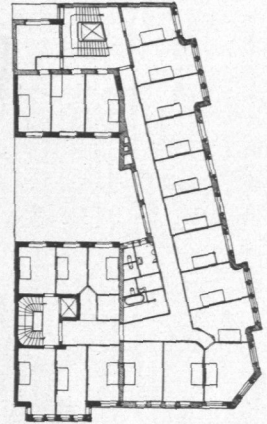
Lloyd-Hotel, Obergeschoß, Grundriß.
